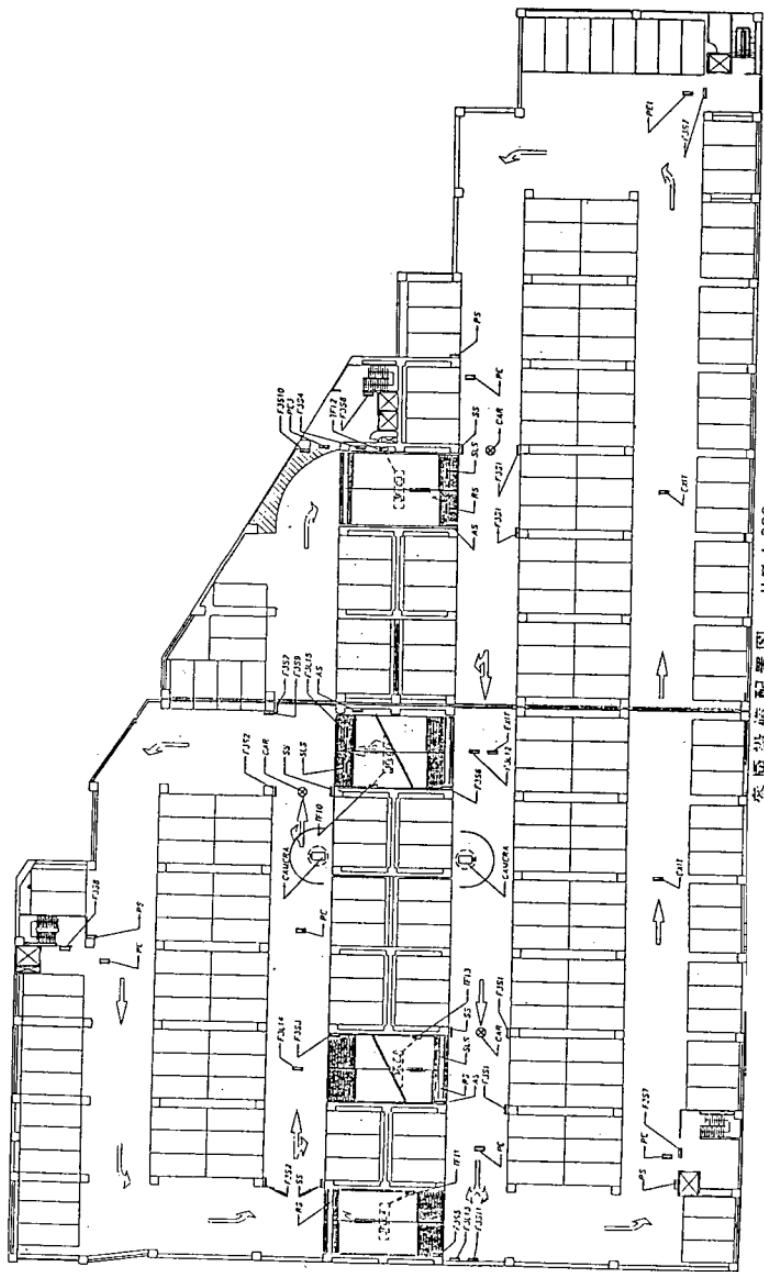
台北市洛陽停車場地上三層小型車設計平面圖
